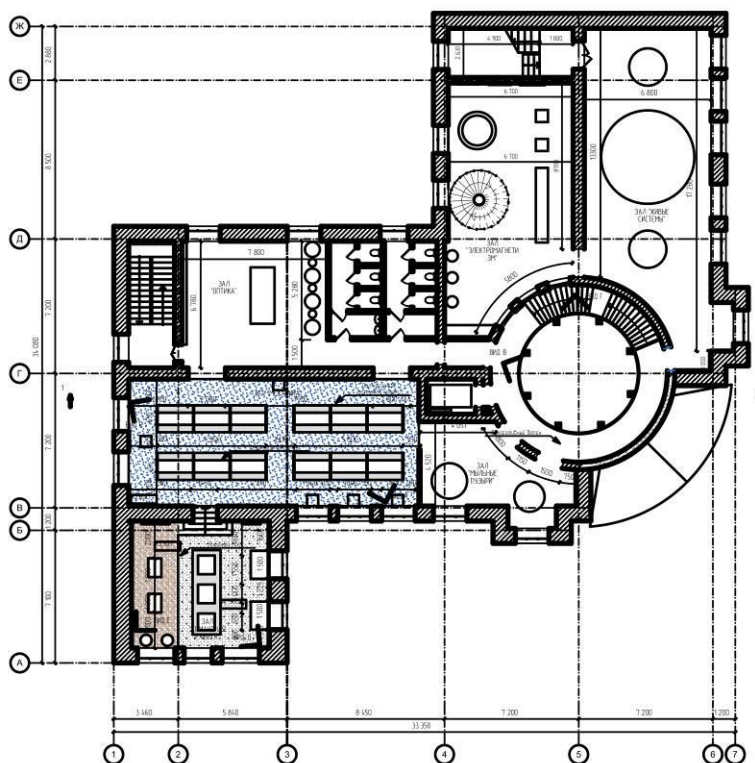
План пола с расстановкой оборудования, 2 этаж
